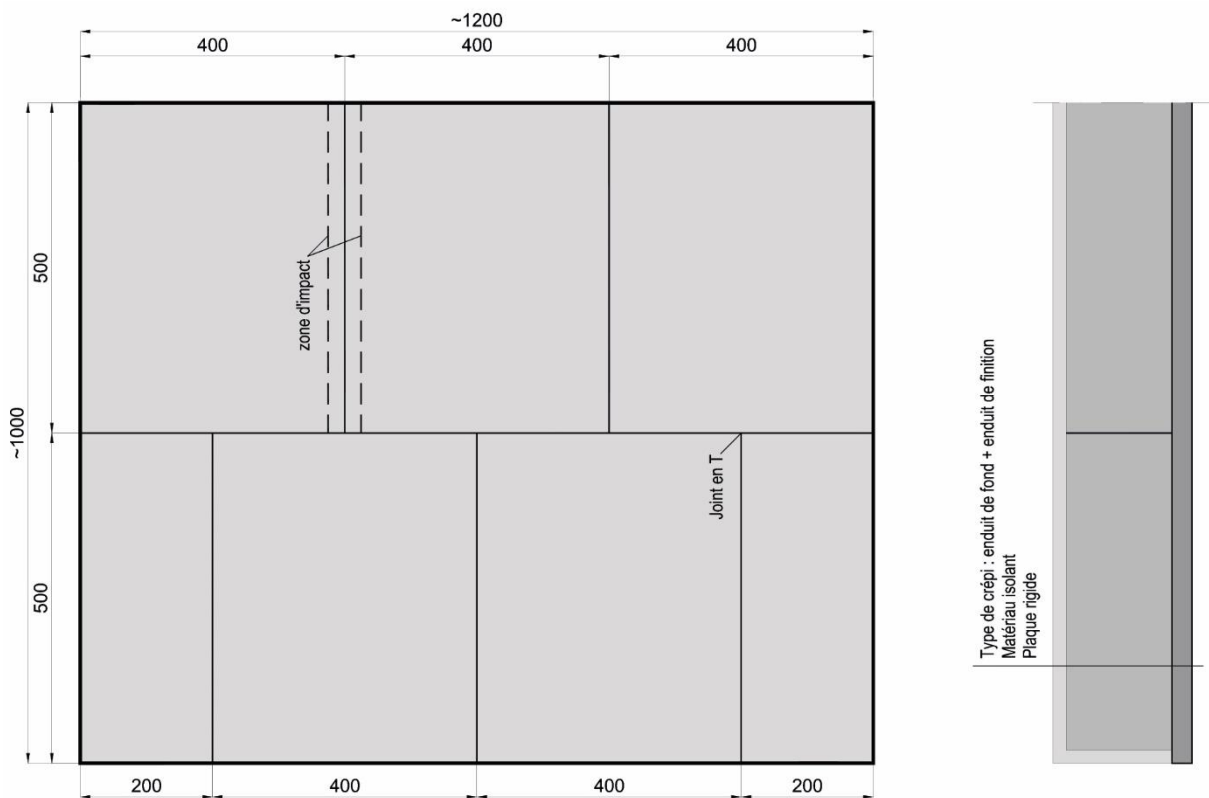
Plan et coupe d'une configuration d'essai possible. Crépi avec plusieurs plaques d'isolation (dimensions en millimètres)
